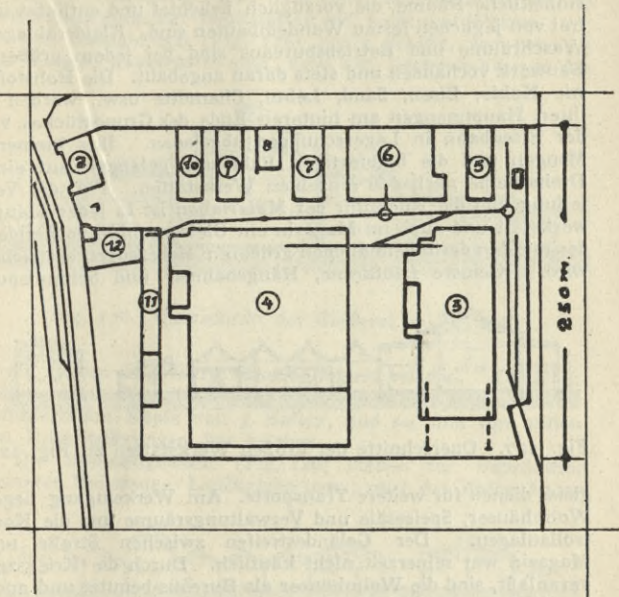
de Fries u. Co., Düsseldorf, Eisengießerei und Maschinenfabrik. Werkplan.
